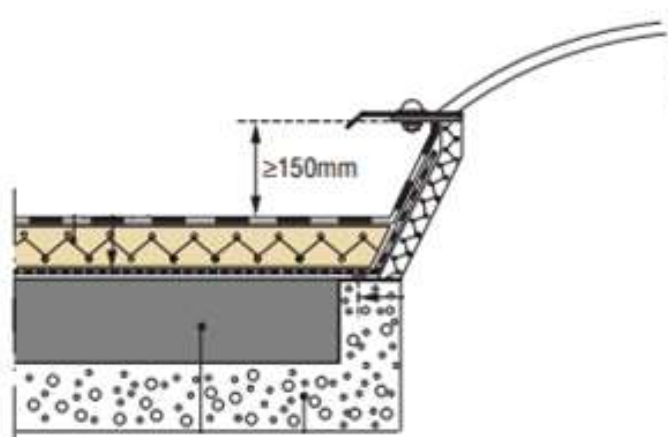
Pormenor construtivo de uma claraboia (CSTC, 1998)
